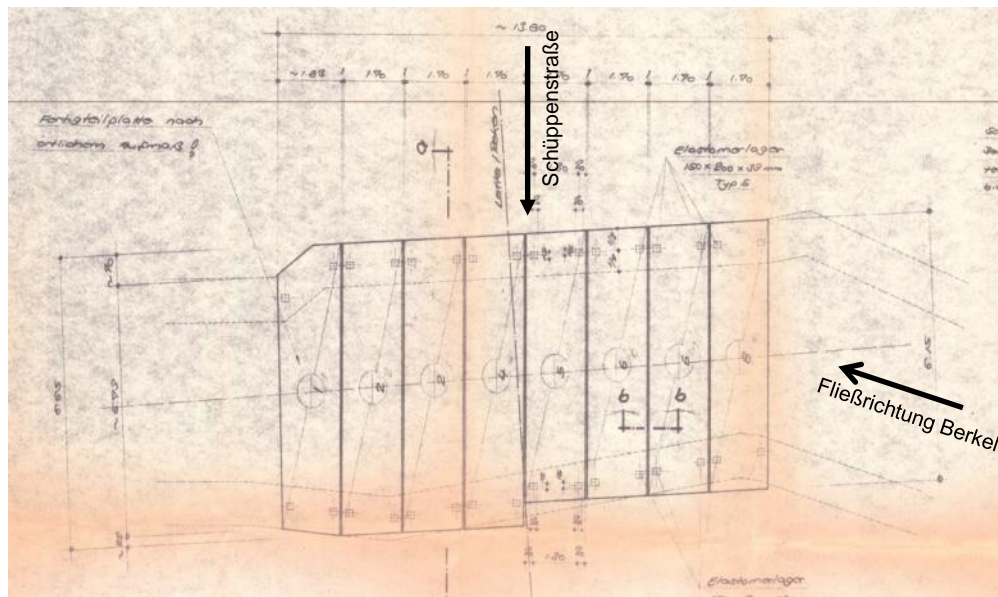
Grundriss Abschnitt 4 gemäß [5]
